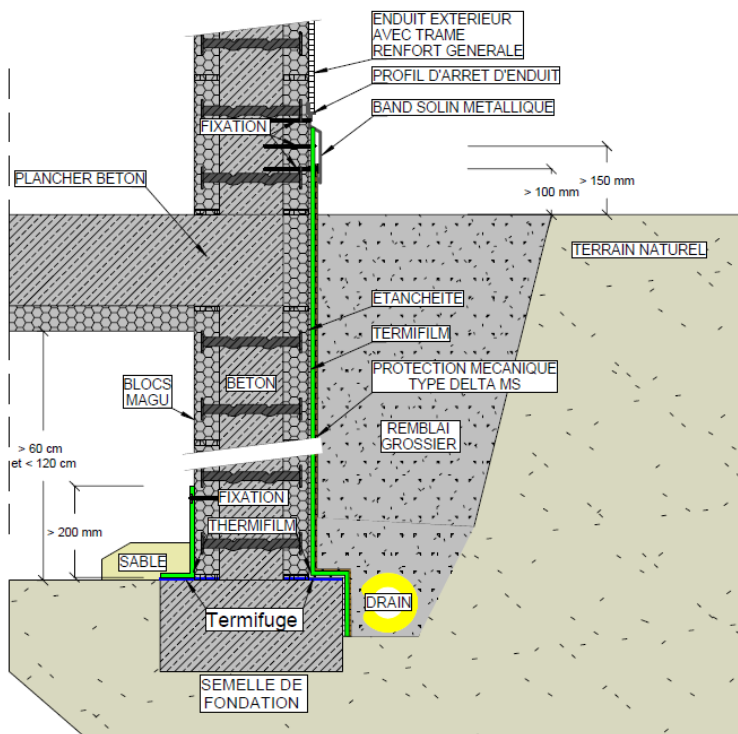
vide sanitaire avec plancher infranchissable ; murs périphériques
